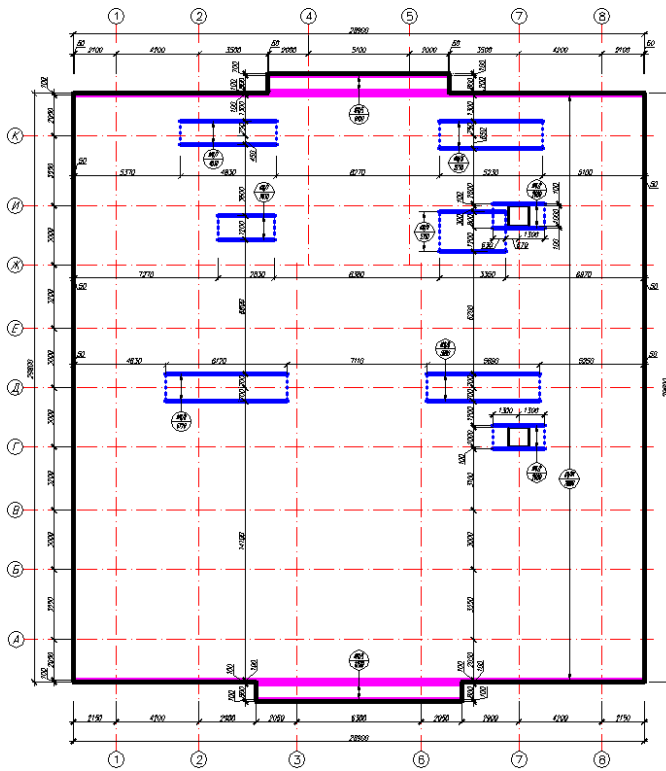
Пример чертежа верхнего армирования по оси X фундаментной плиты жилого дома
